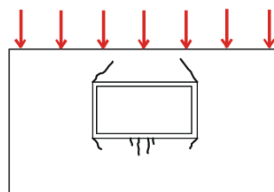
Fissuras horizontais causadas por sobrecarga
